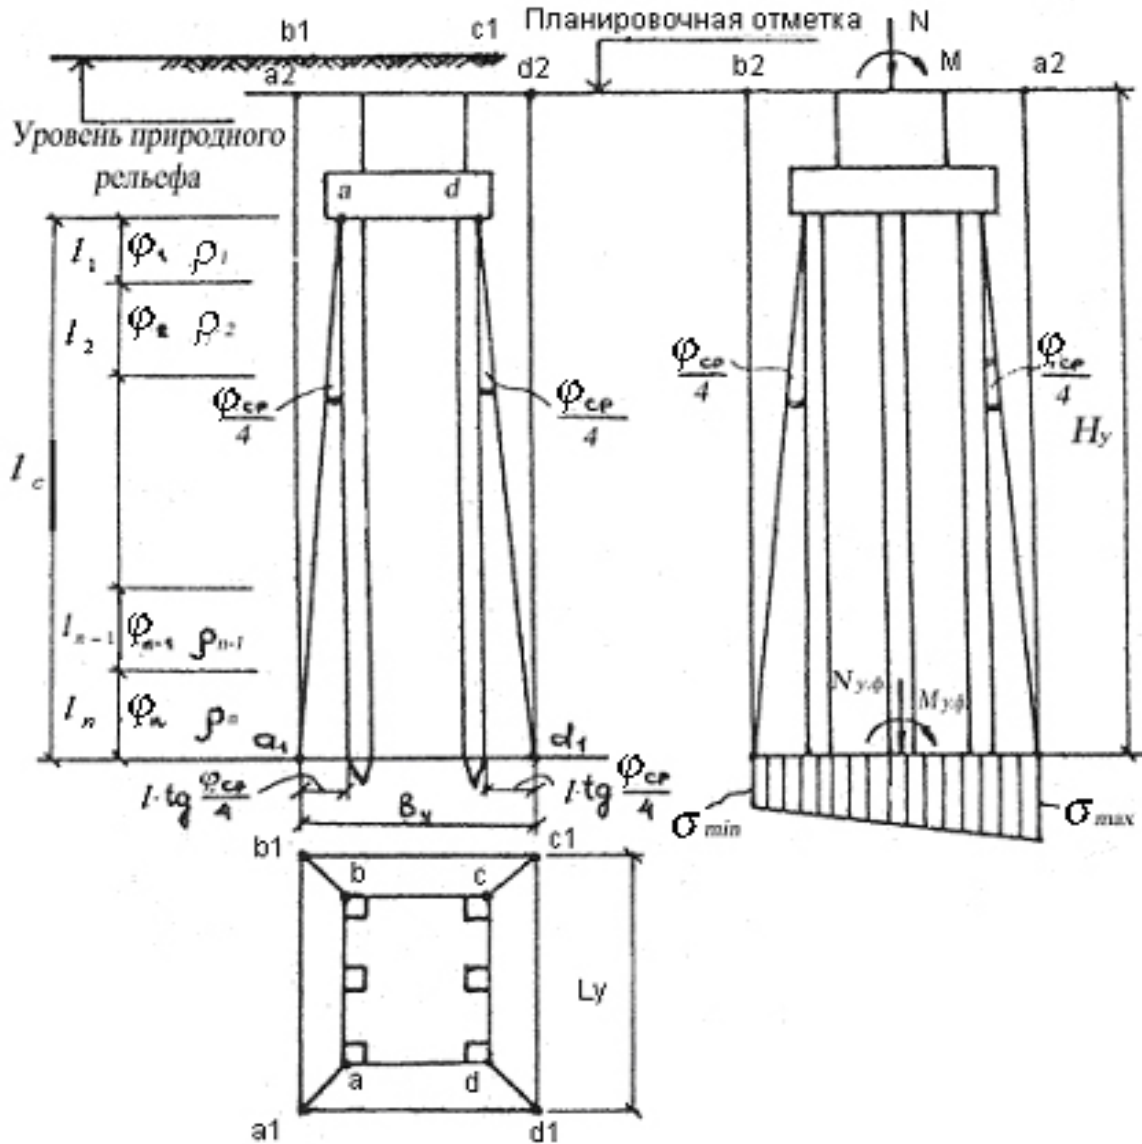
Схема определения размеров грунто-свайного массива (условного фундамента) для расчета осадок кустового свайного фундамента
